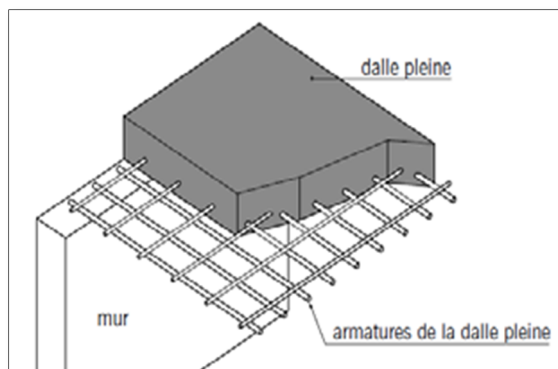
Détails de la dalle pleine. Source : PDF: Construire en béton
